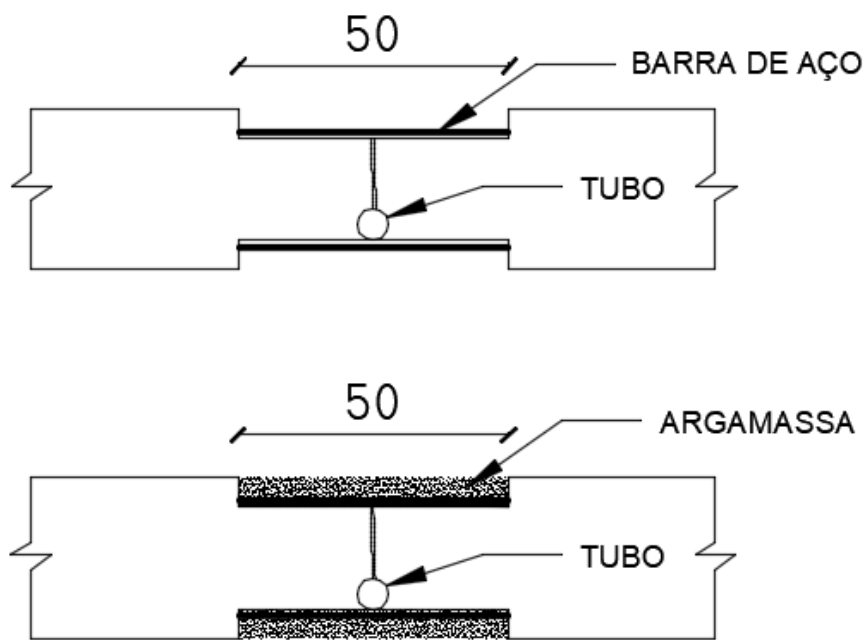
Vista em planta da inserção de barras de aço em elemento de alvenaria fissurado. Fonte: adaptado de Thomaz (1989).
